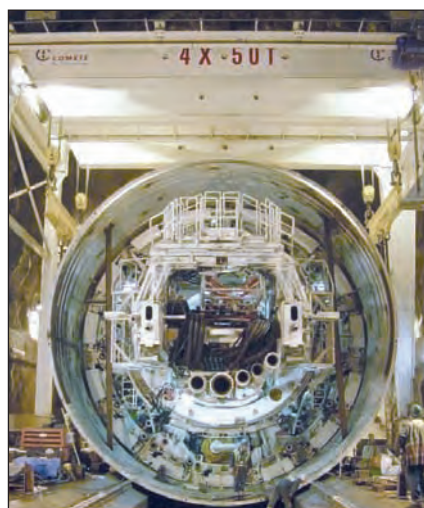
Assemblage du bouclier dans la caverne souterraine.
